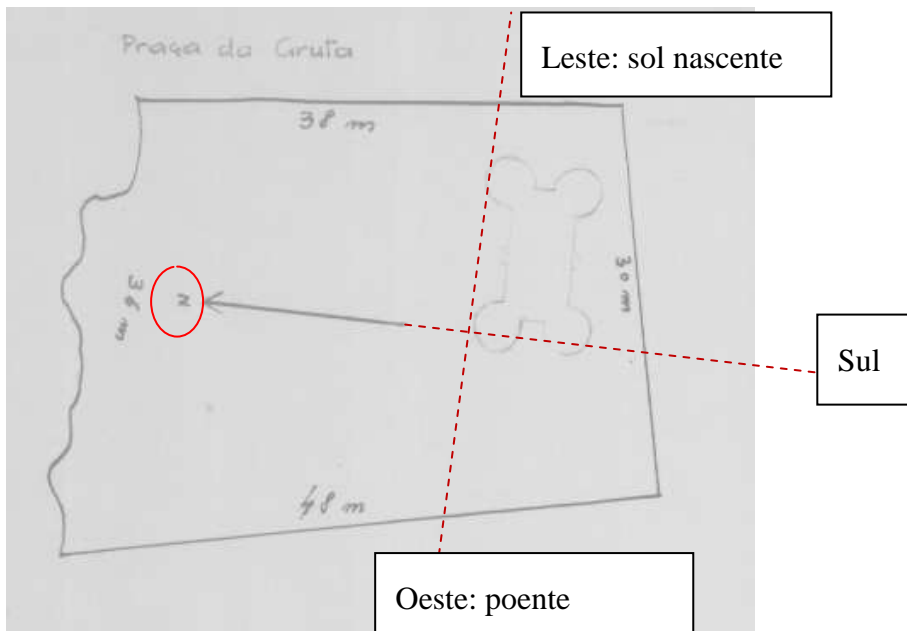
Planta de situação com indicação das coordenadas geográficas.²⁷
